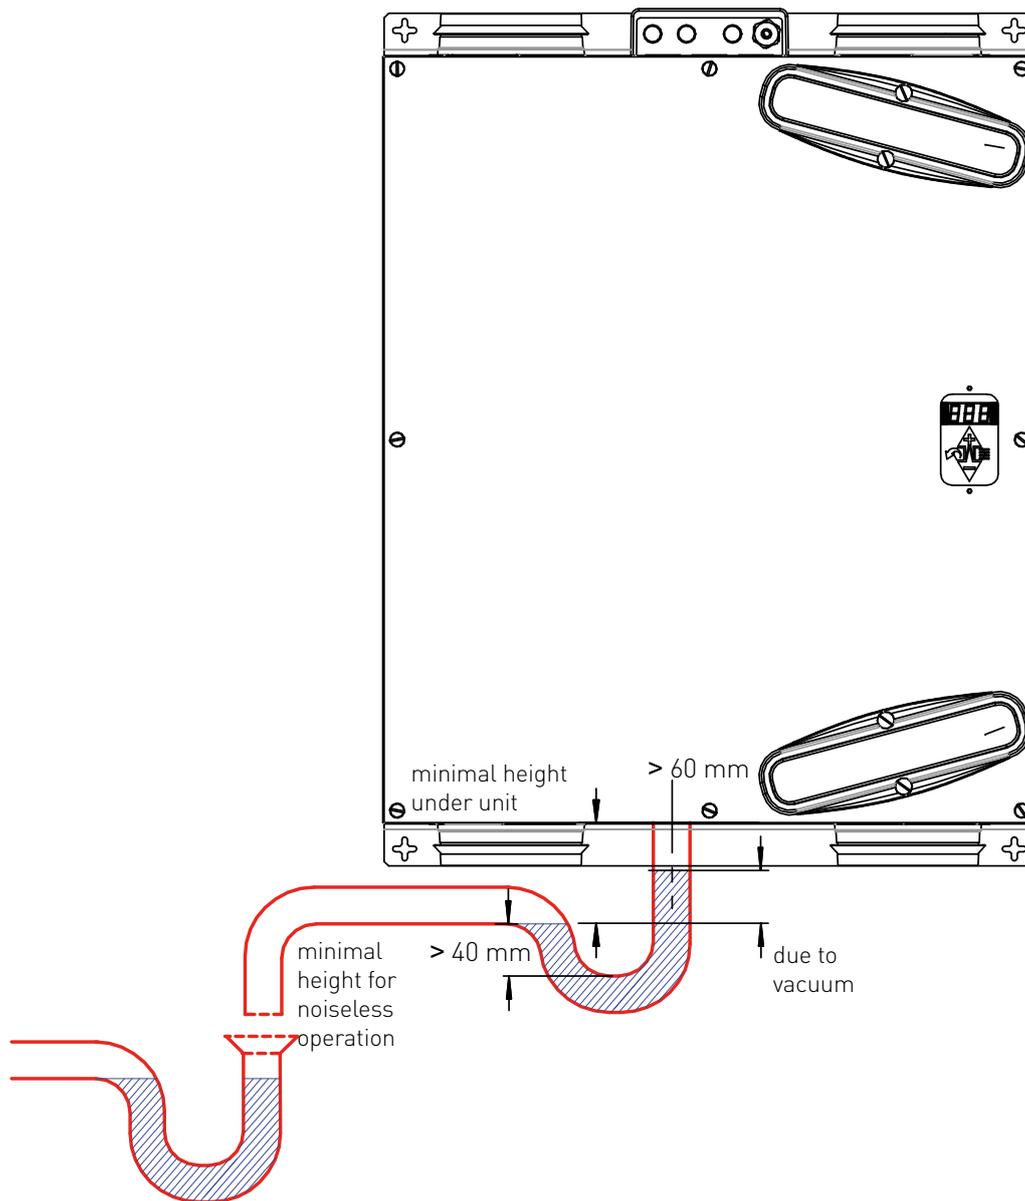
B: MONTAGE MURAL AVEC COUPE-AIR À BOULE
